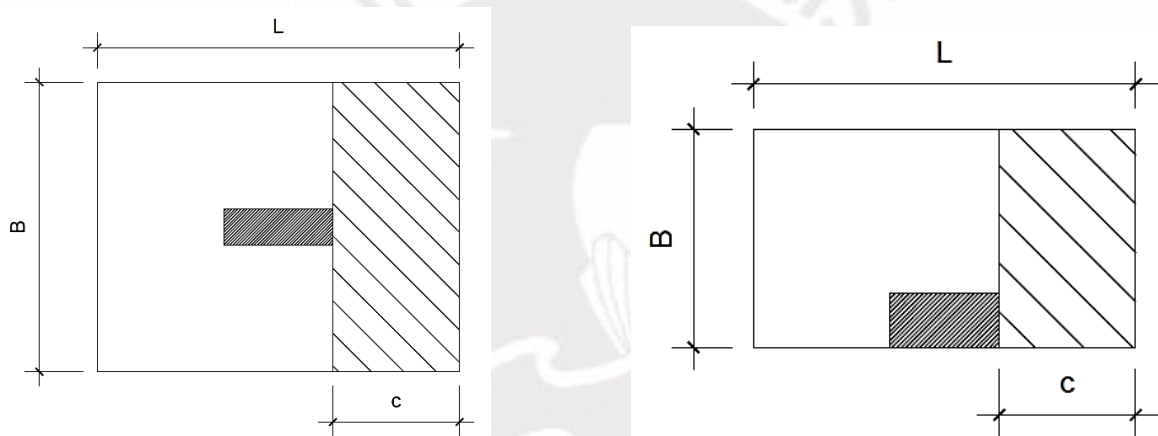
Esquema típico de sección crítica en zapatas aisladas y laterales – diseño por punzonamiento
